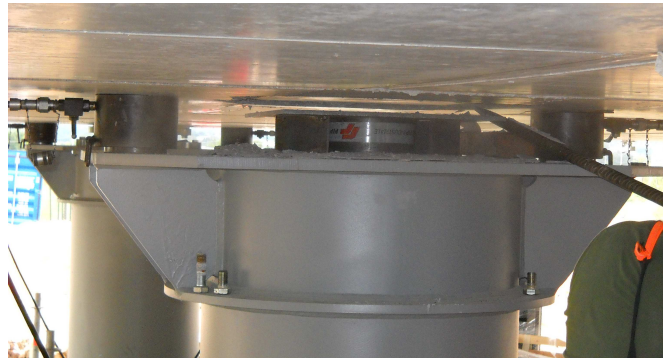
Particolare del posizionamento dei martinetti e trasferimento diretto dei carichi alla sottostruttura
